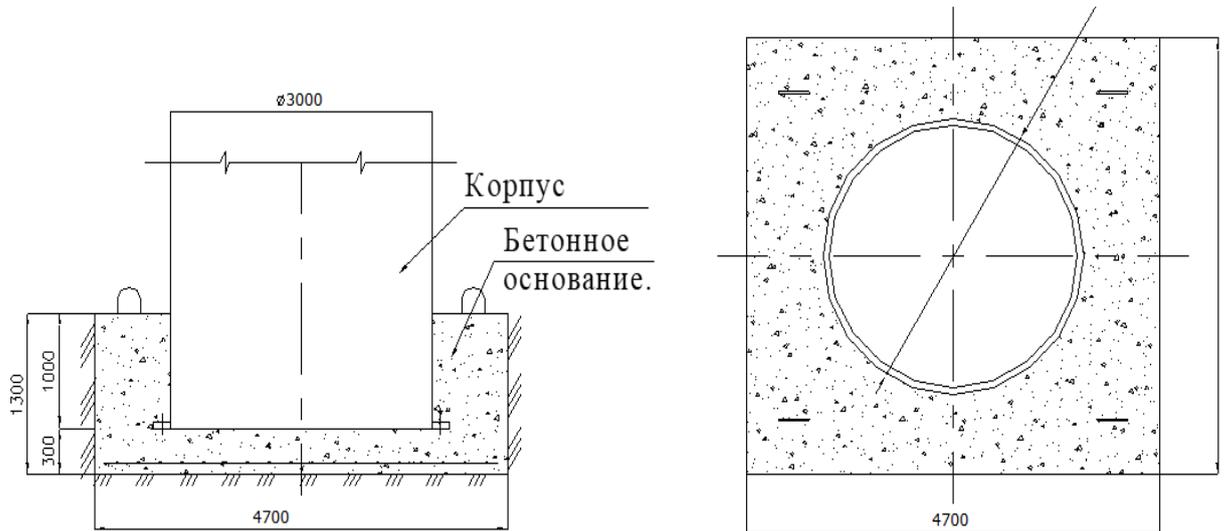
Схема изготовления пригруза для стеклопластикового колодца
